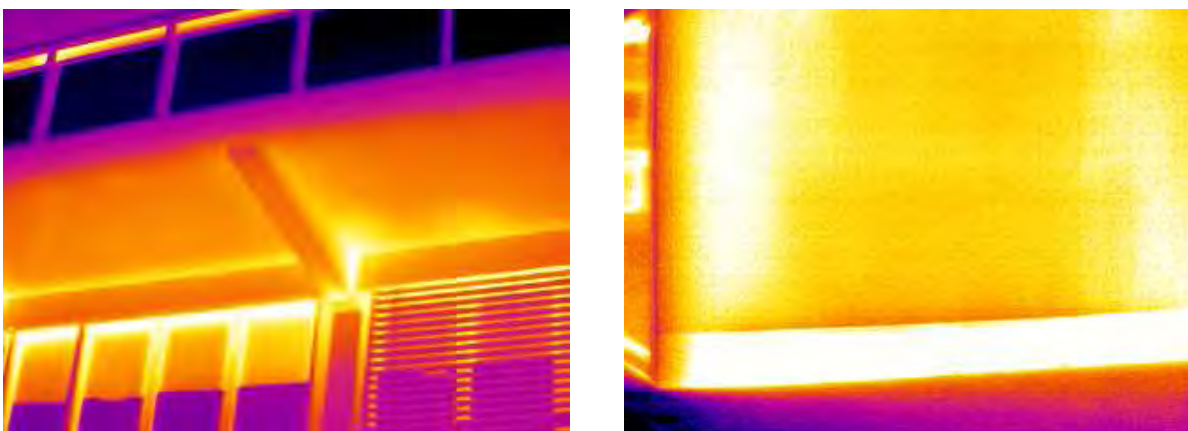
Thermographie non-traitée du bâtiment Giacometti. Gauche : console façade sud-ouest. Droite : pignon nord-ouest.
